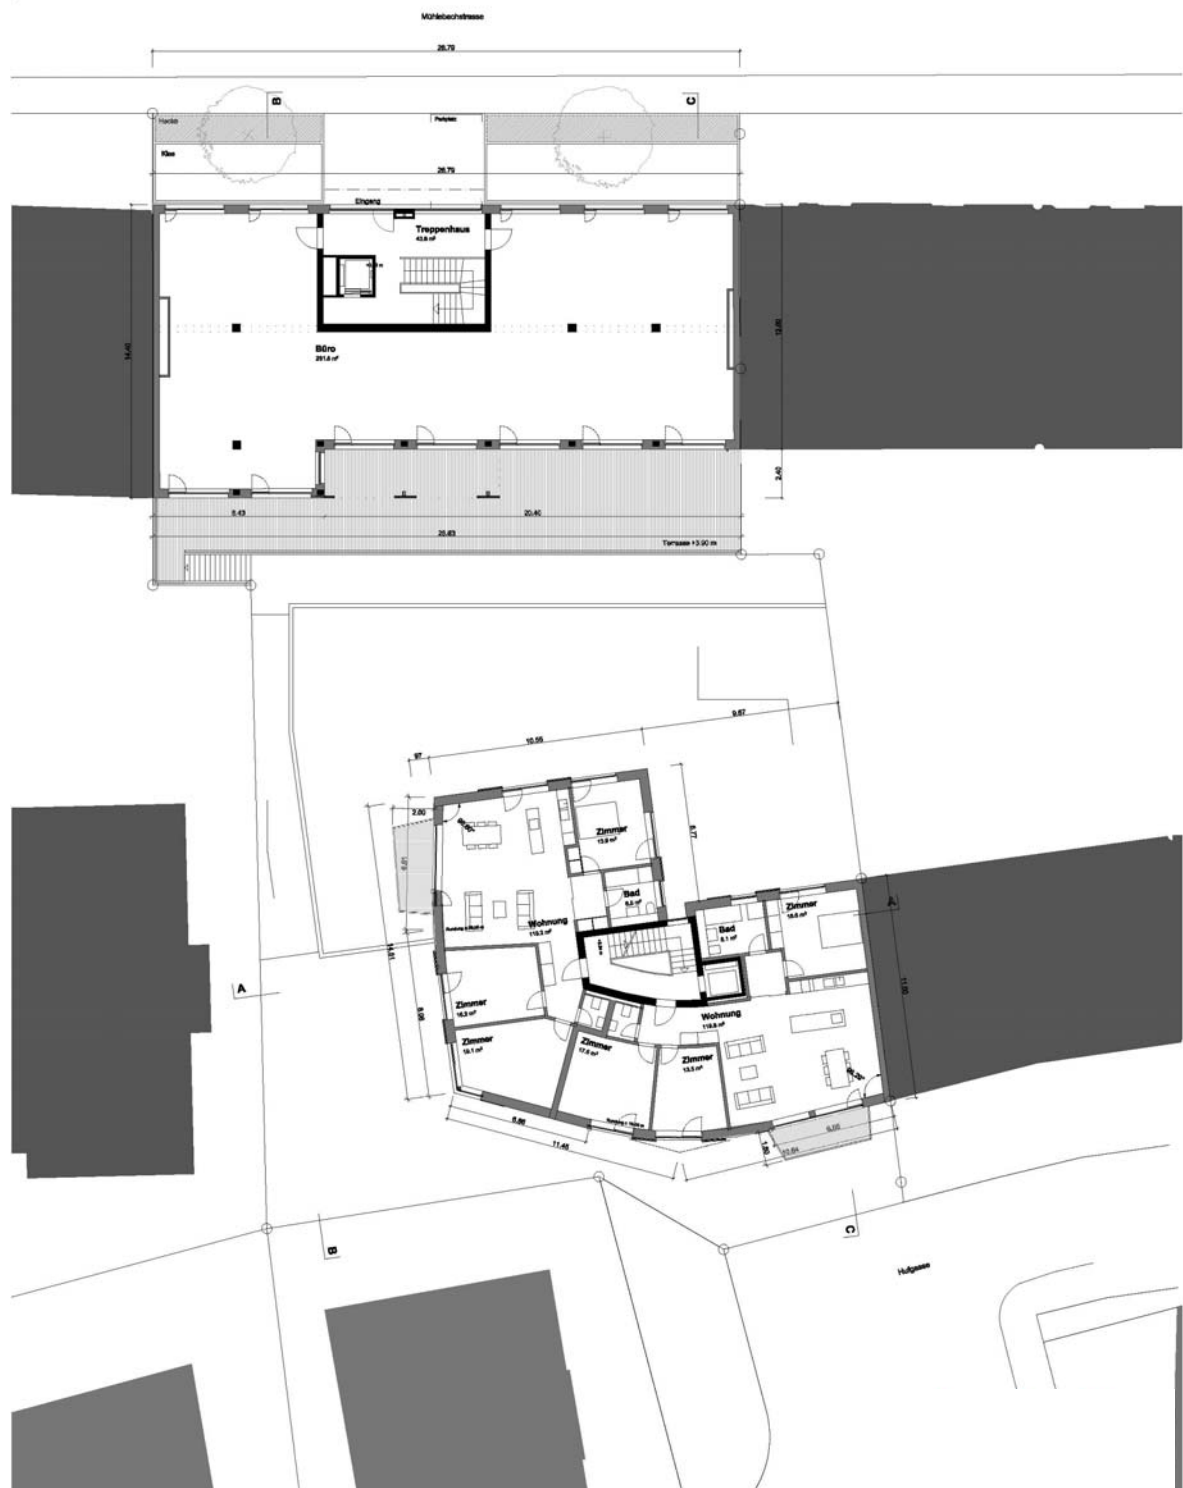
Provisorischer Grundriss EG, Wohn- und Bürogebäude Mühlebachstr. 8 und Hufgasse 11, Zürich
